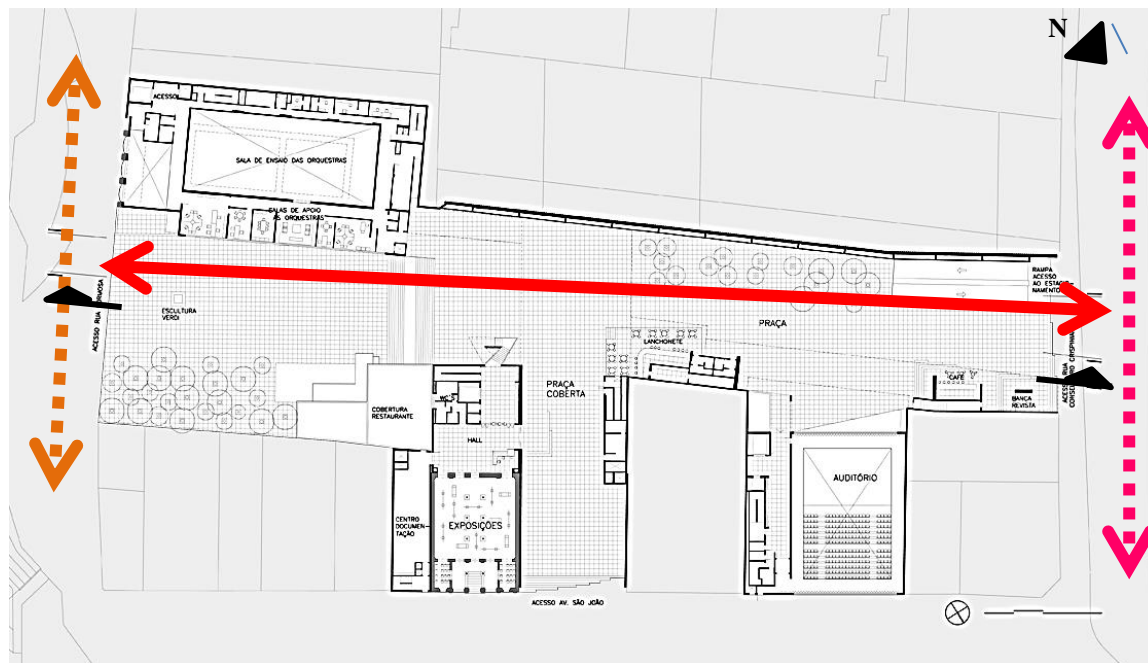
Planta terrea Praça das Artes. FONTE Archdaily
